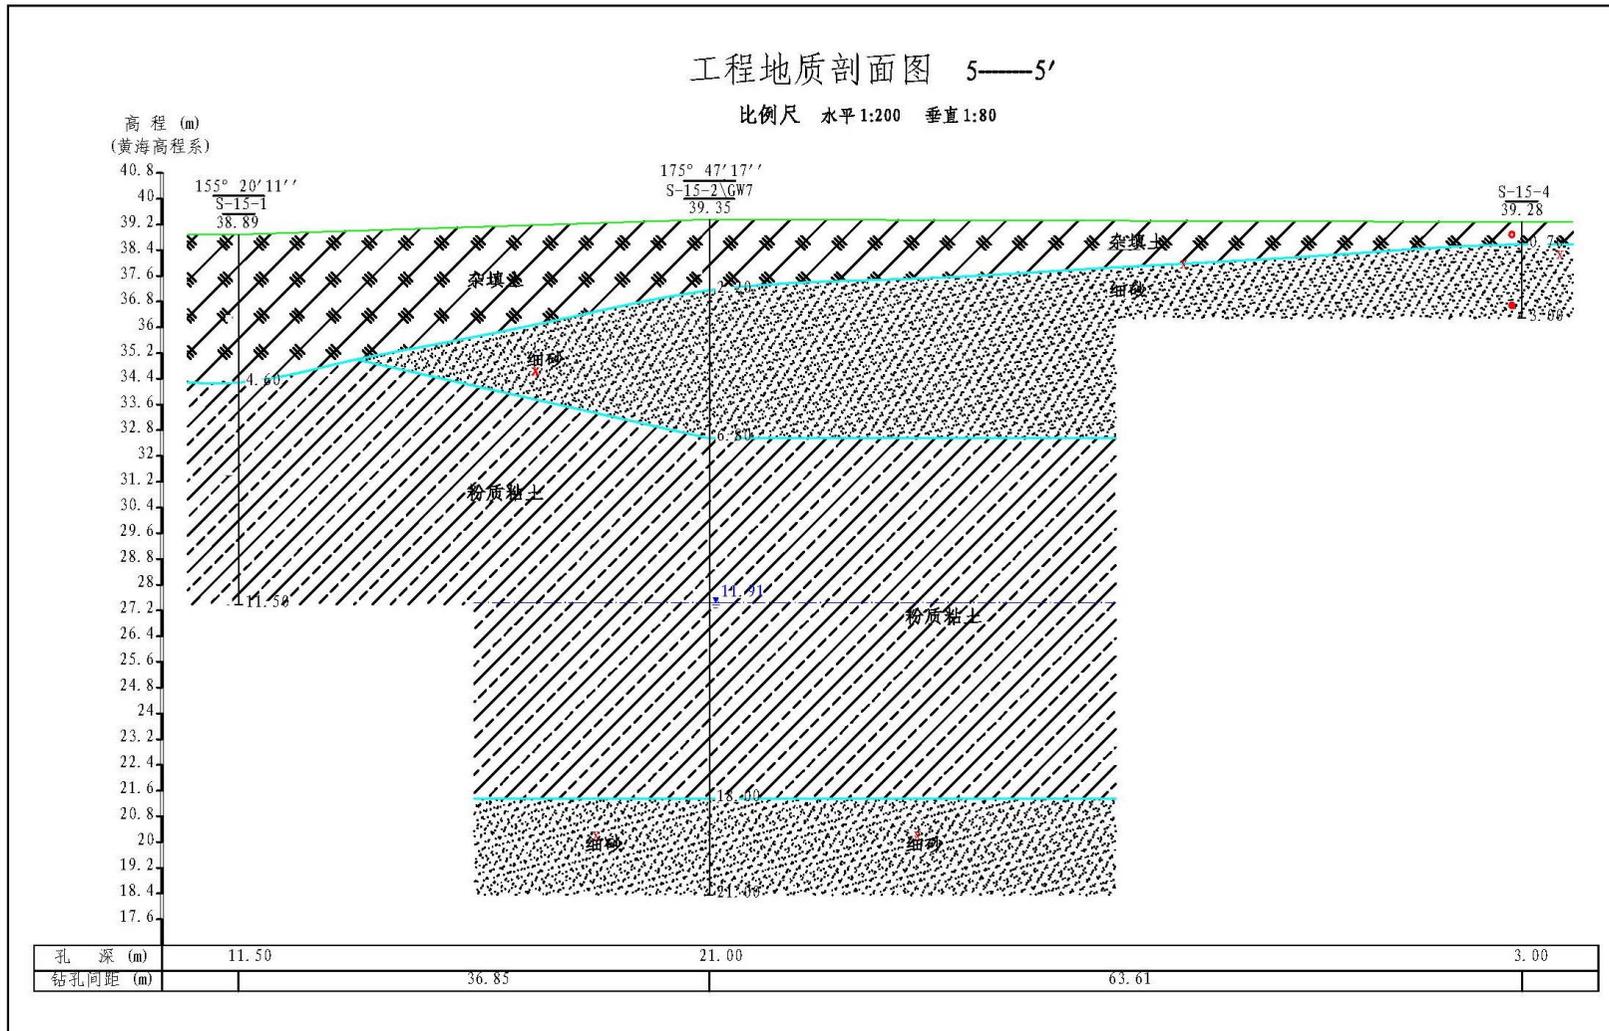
剖面线 5-5'地质剖面图 (纵向)
